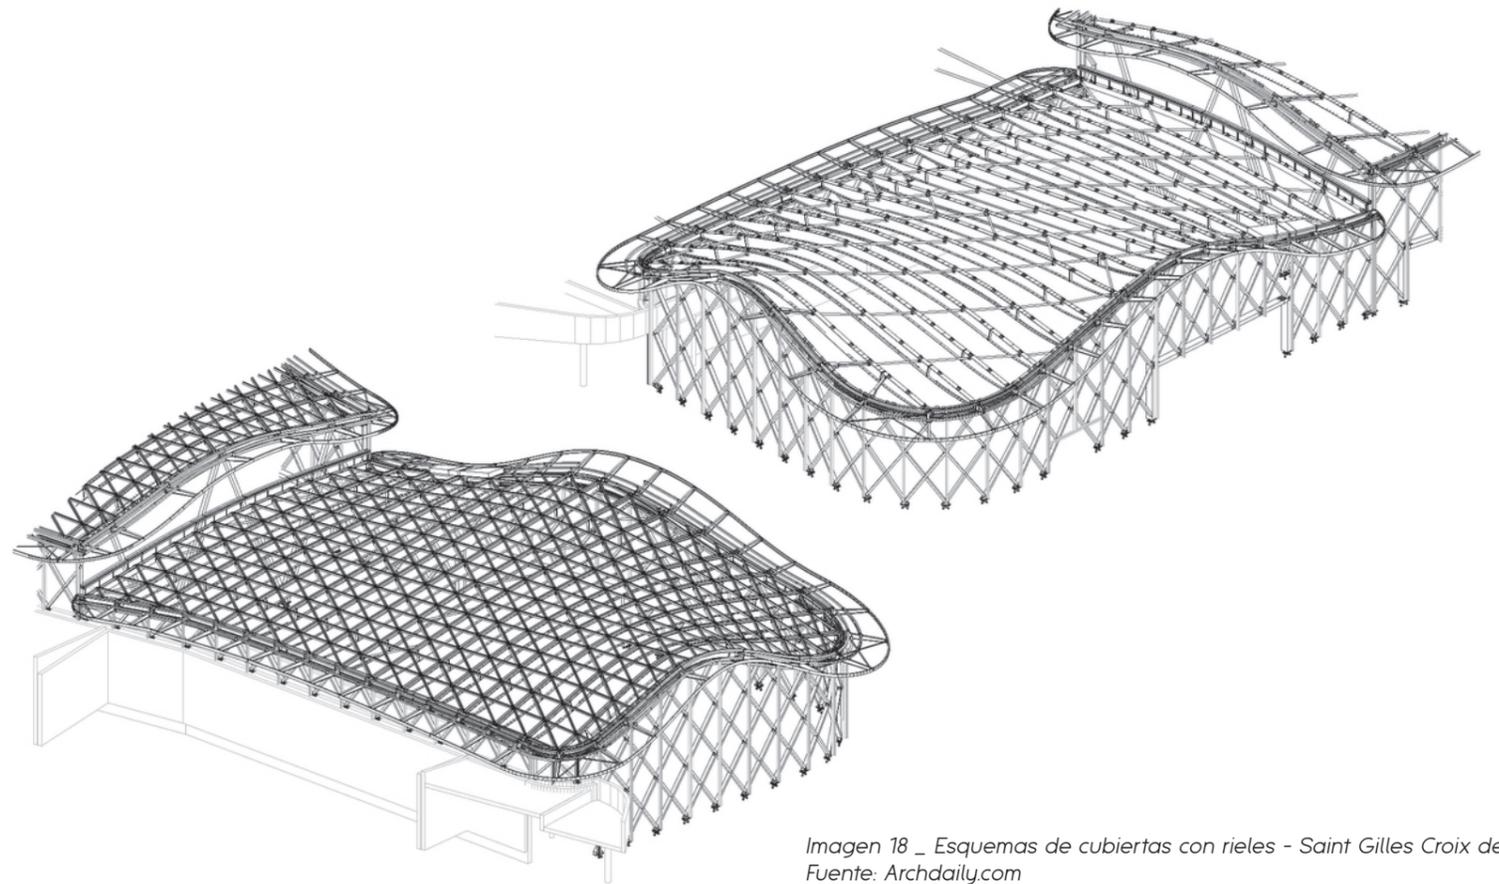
Esquemas de cubiertas con rieles - Saint Gilles Croix de Vie
